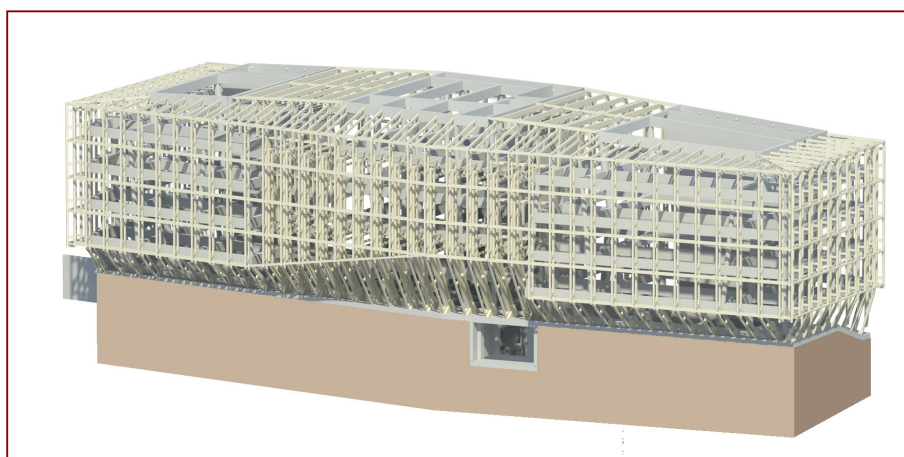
3D strutturale - Sotto struttura reticolare in legno.
